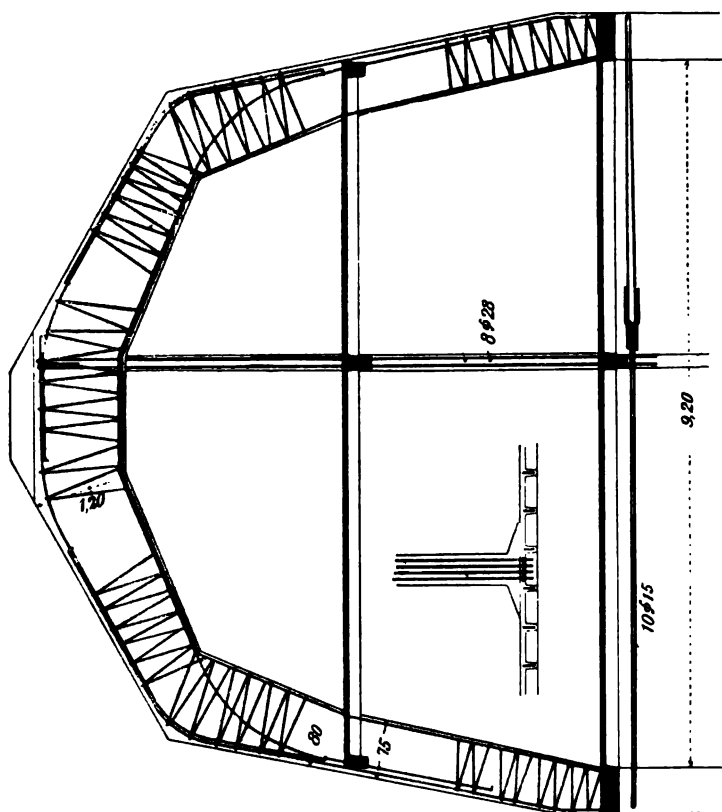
Mansardbogen mit Bewehrung und Hängesäulen.
